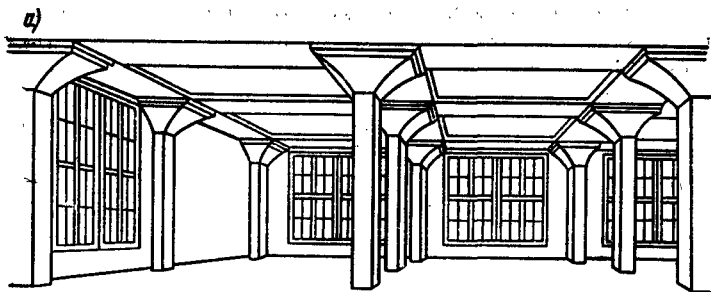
Конструкция безбалочного сборного перекрытия с ребристыми панелями
